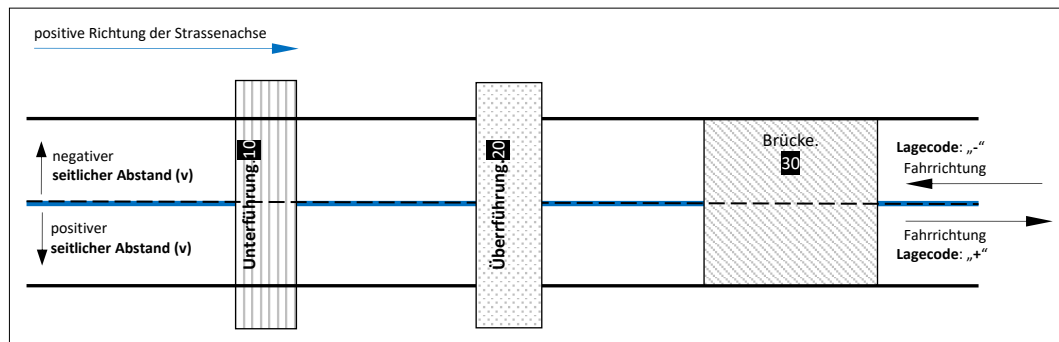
„BSA auf offener Strecke“: Nummerierung von Strecken-Bauwerken.
